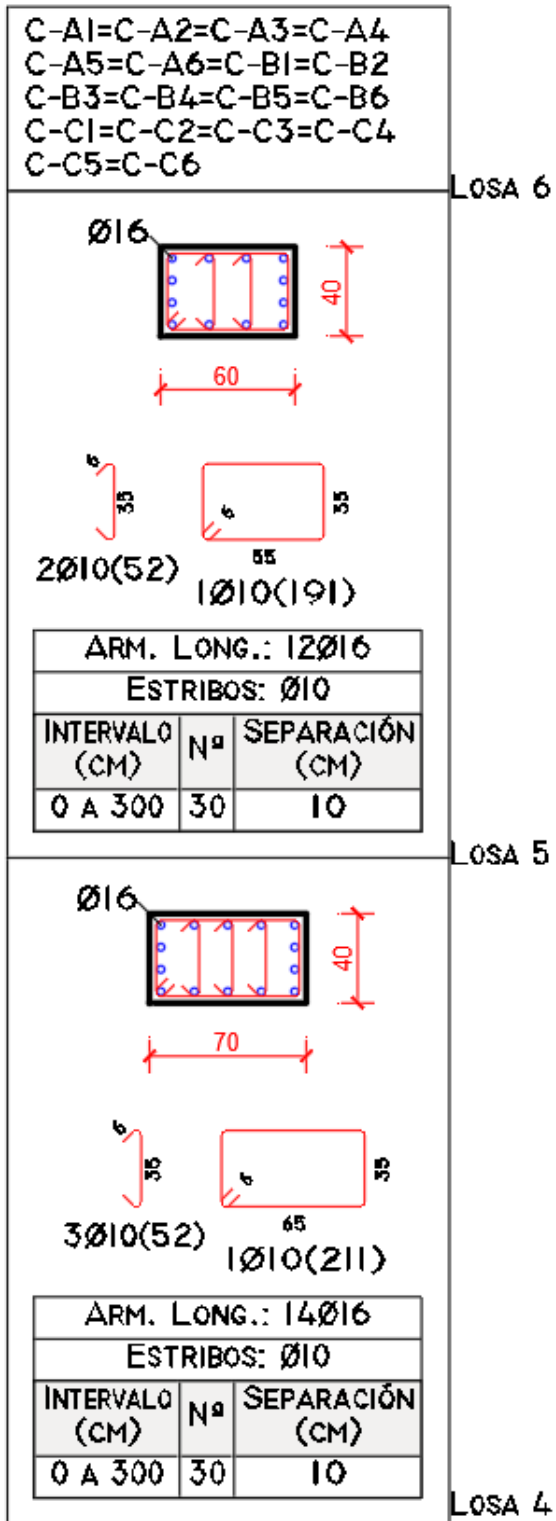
Detalle de Refuerzo Columnas, de Losa 4 a Losa 6, Estructura [7N-CS].
